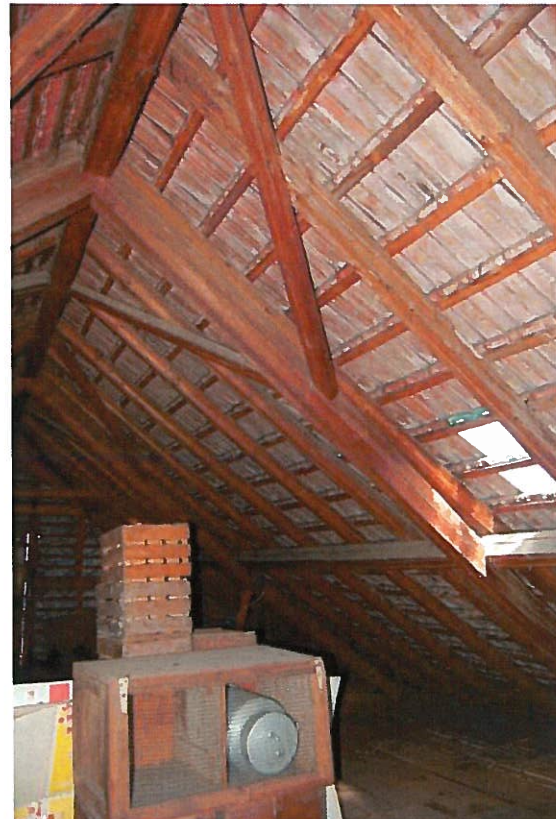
Ehemalige Ökonomie, 2. Dachgeschoss, Blick Richtung Westen.
